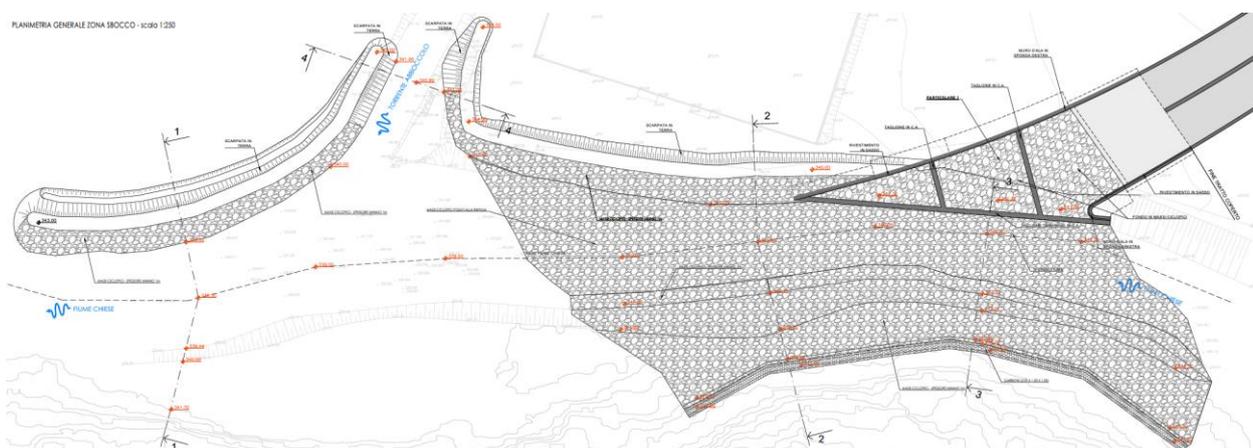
Planimetria opere di restituzione e di protezione confluenza galleria di by-pass / Chiese nel PE (elaborato: PE-ALV-ZSB-GE-001-PT-A)
